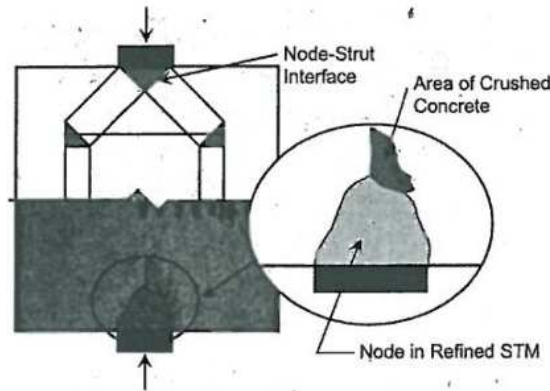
Modo de fallo típico en los ensayos de bielas aisladas[12]
